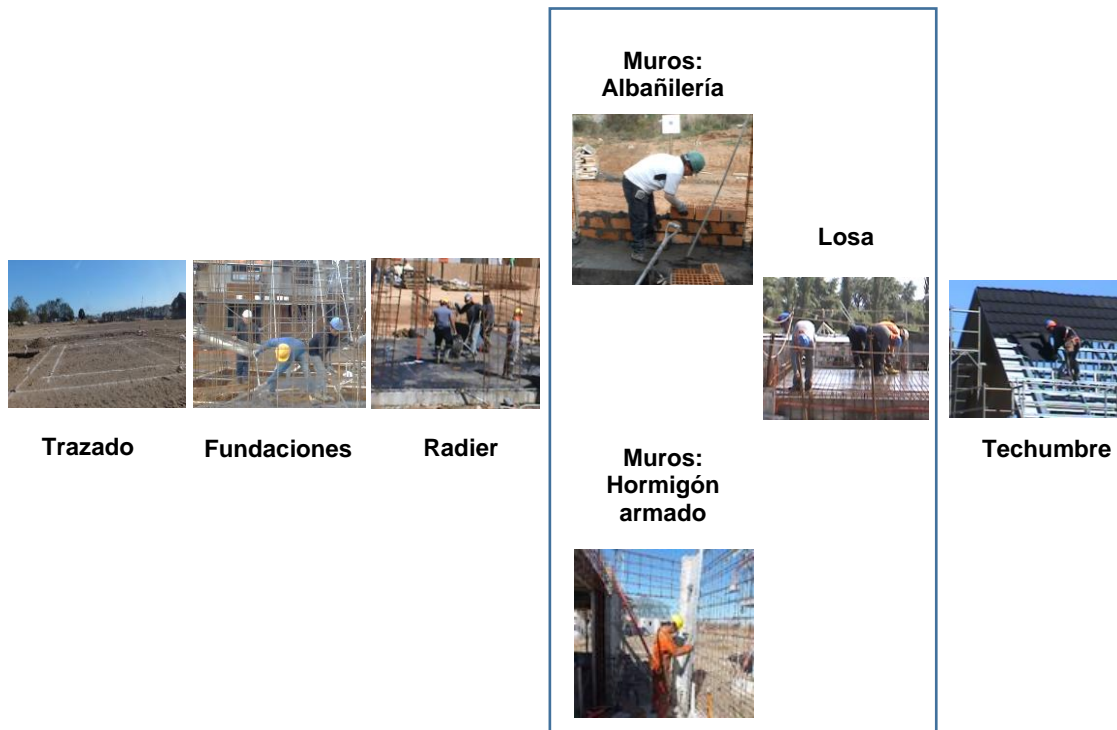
Etapas más relevantes de obra gruesa destacando aquellas en las que se centró este estudio: Construcción de muros y losa del primer piso de viviendas.
